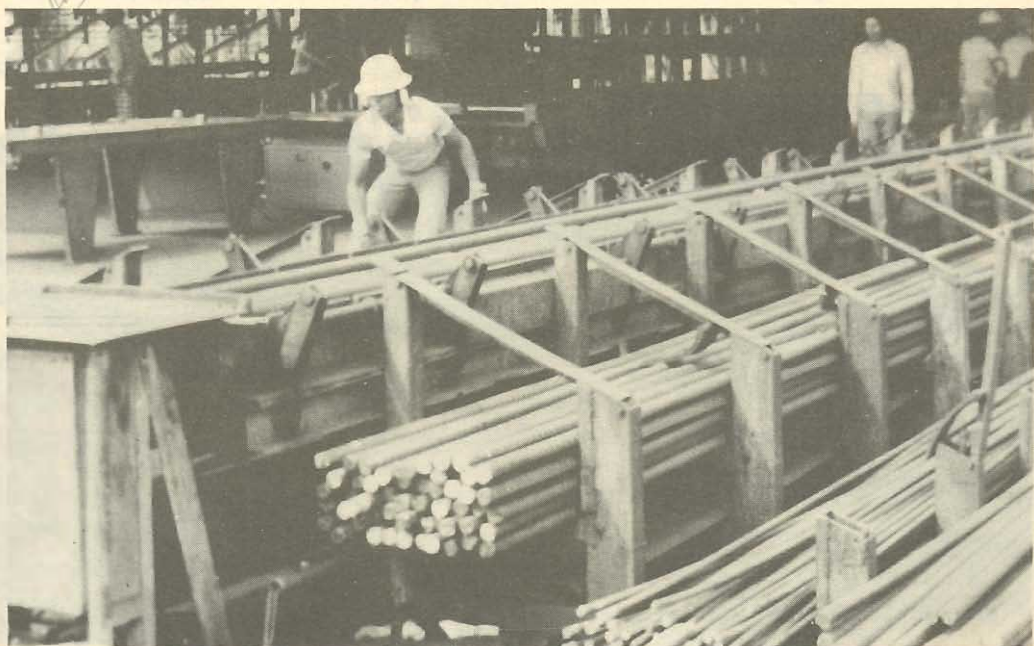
Prateleiras de barras retas cortadas - Itaipu
